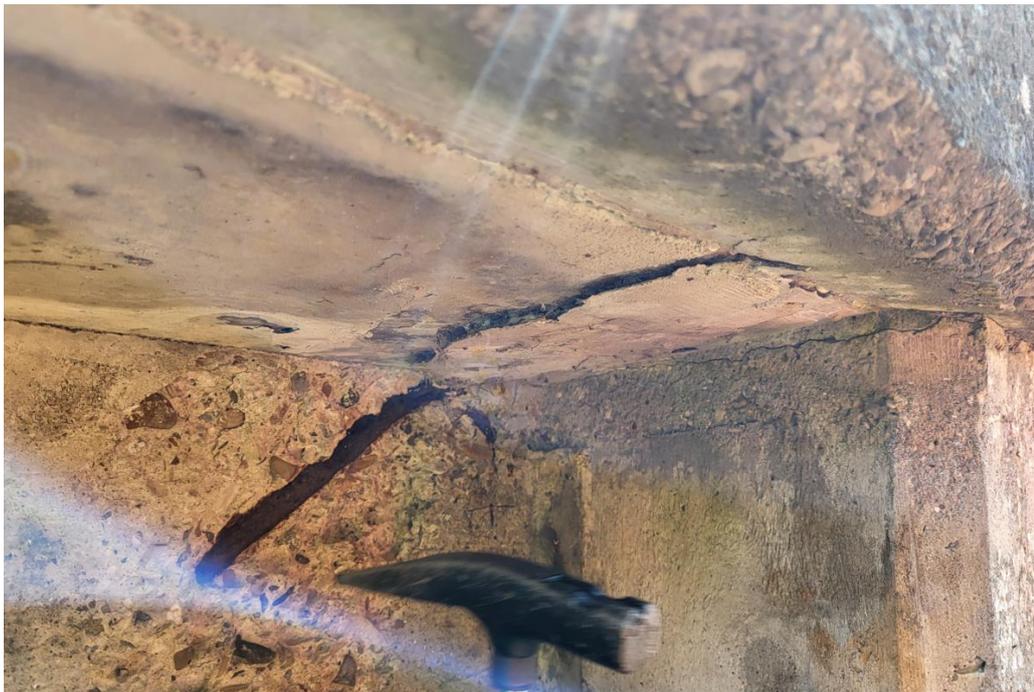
Steg im Auflagerbereich mit freiliegender korrodierter Schubbewehrung und neuen Betonabplatzungen
